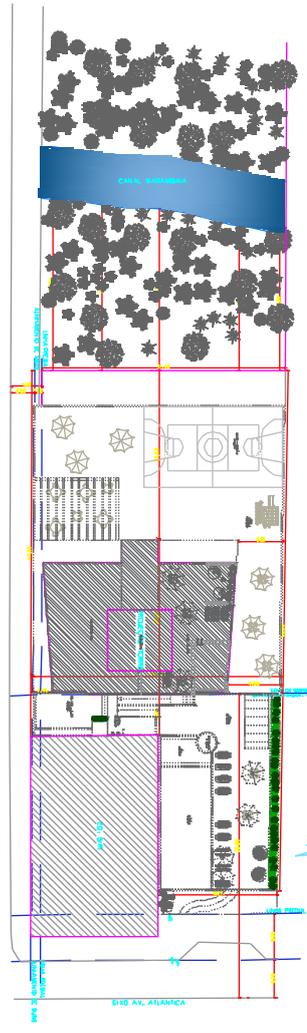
Detalhe da planta baixa de implantação do empreendimento BOREAL TOWER.
